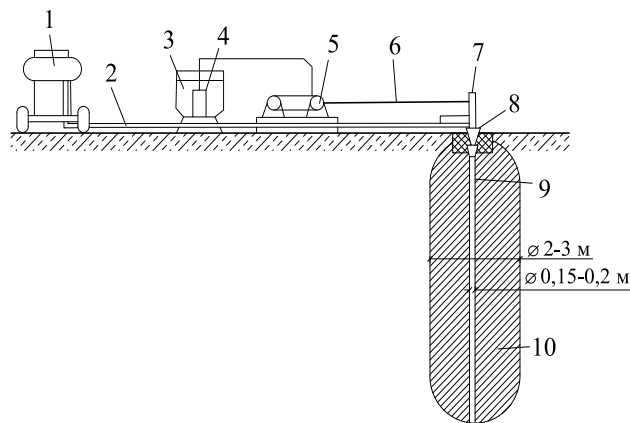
Схема установки для термічного закріплення ґрунту спалюванням палива у свердловині: 1 – компресор; 2 – трубопровід холодного повітря; 3 – рідке паливо; 4 – фільтр; 5 – насос для подачі палива; 6 – трубопровід для подачі палива до форсунок; 8 – засув свердловини з камерою згорання; 9 – свердловина; 10 – зона термічного закріплення
